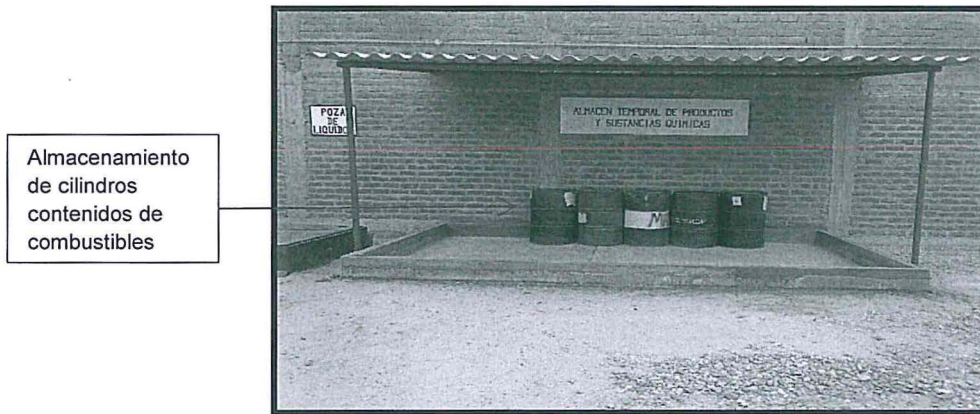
Almacén con losa de concreto con junta dilatadora impermeabilizada y con dique de concreto
